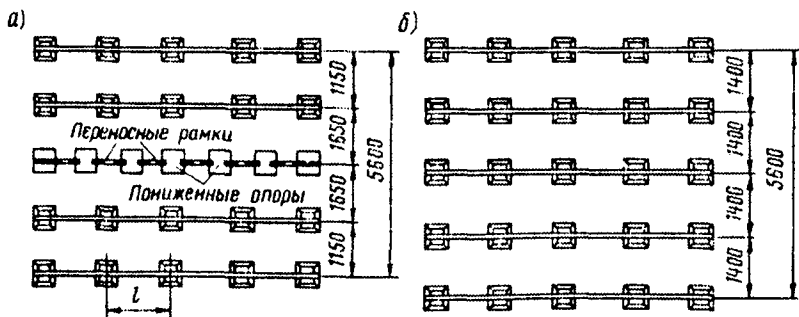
Фундаменты для пакетных штабелей пиломатериалов: а — формируемые автопогрузчиком; б — формируемые краном
